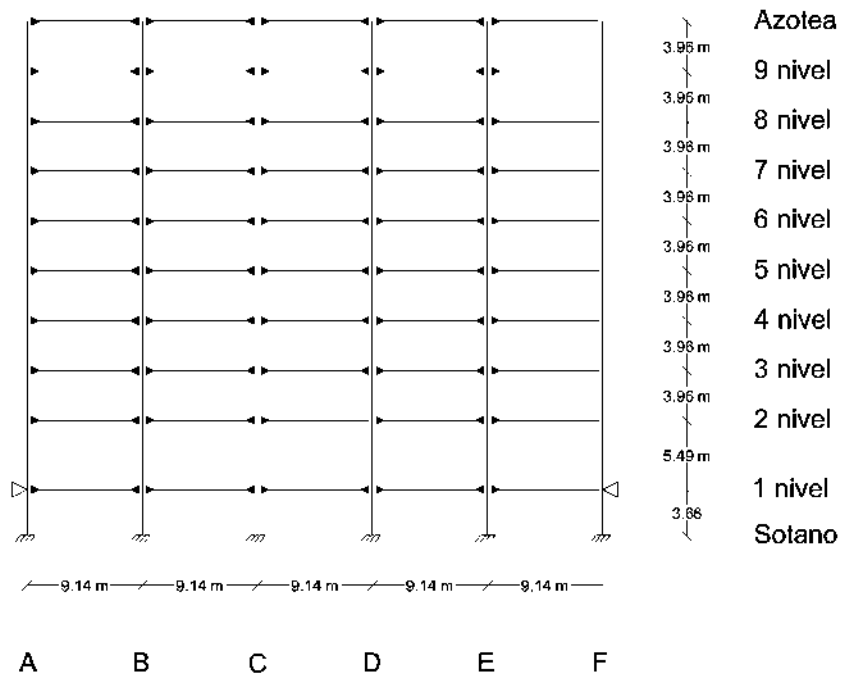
Vista en elevación del edificio de 9 niveles.
